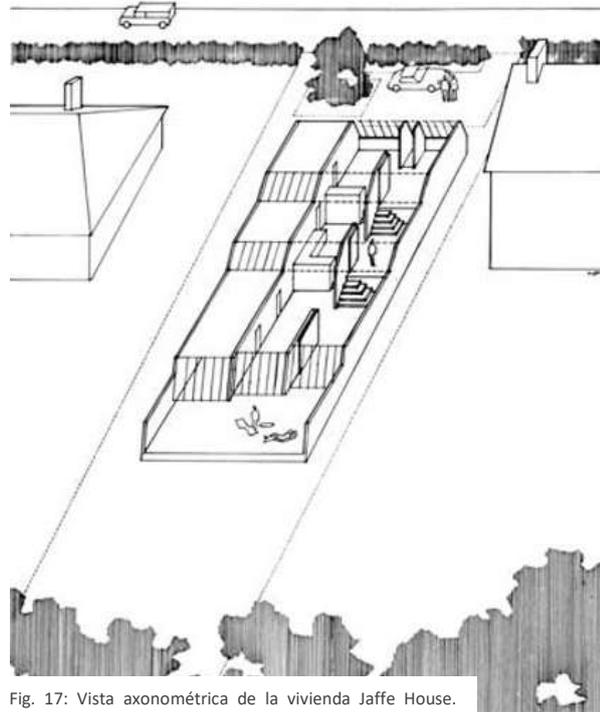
Vista axonométrica de la vivienda Jaffe House.
